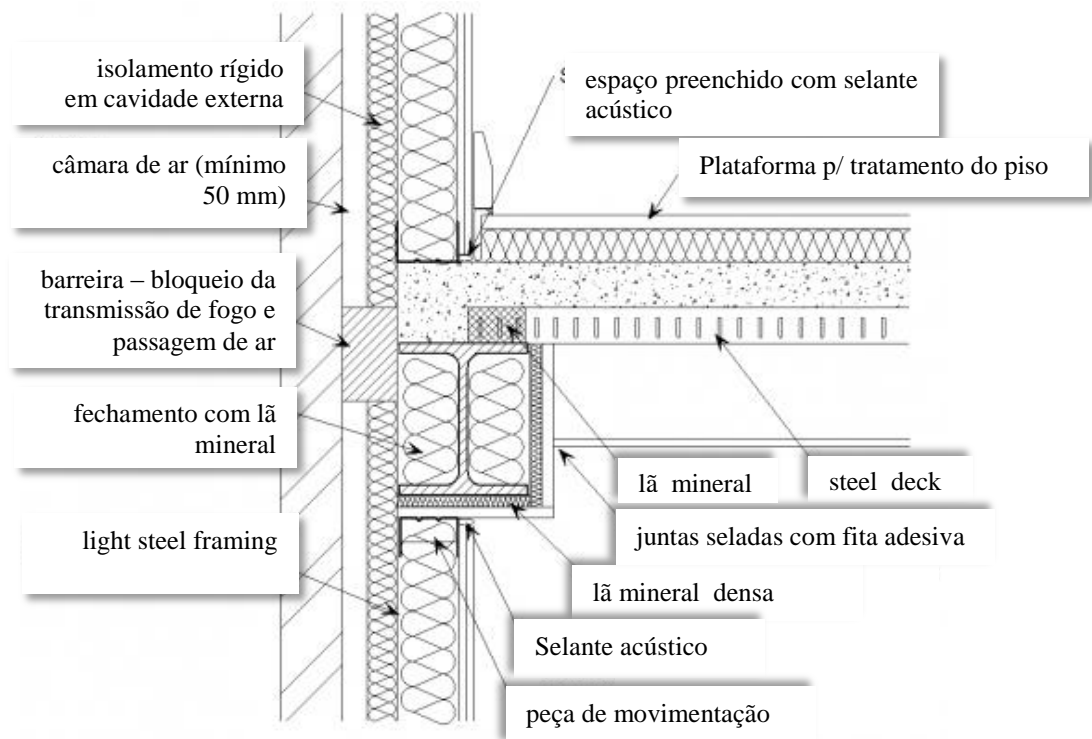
Corte esquemático que apresenta o detalhe de isolamento da viga metálica isolada das com lâ mineral. Fonte: Way e Couchman (2008).
